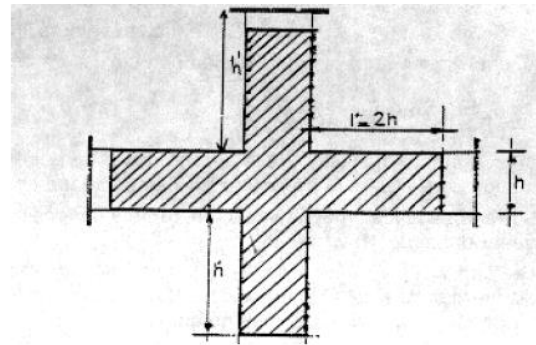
zone nodale des poteaux (RPA7.2 page 71).
